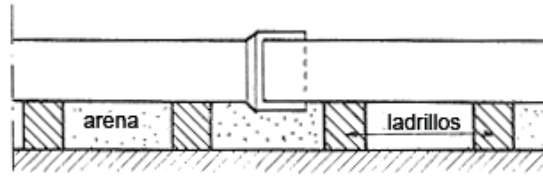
COLOCACIÓN DE TUBERÍA SOBRE LADRILLOS
